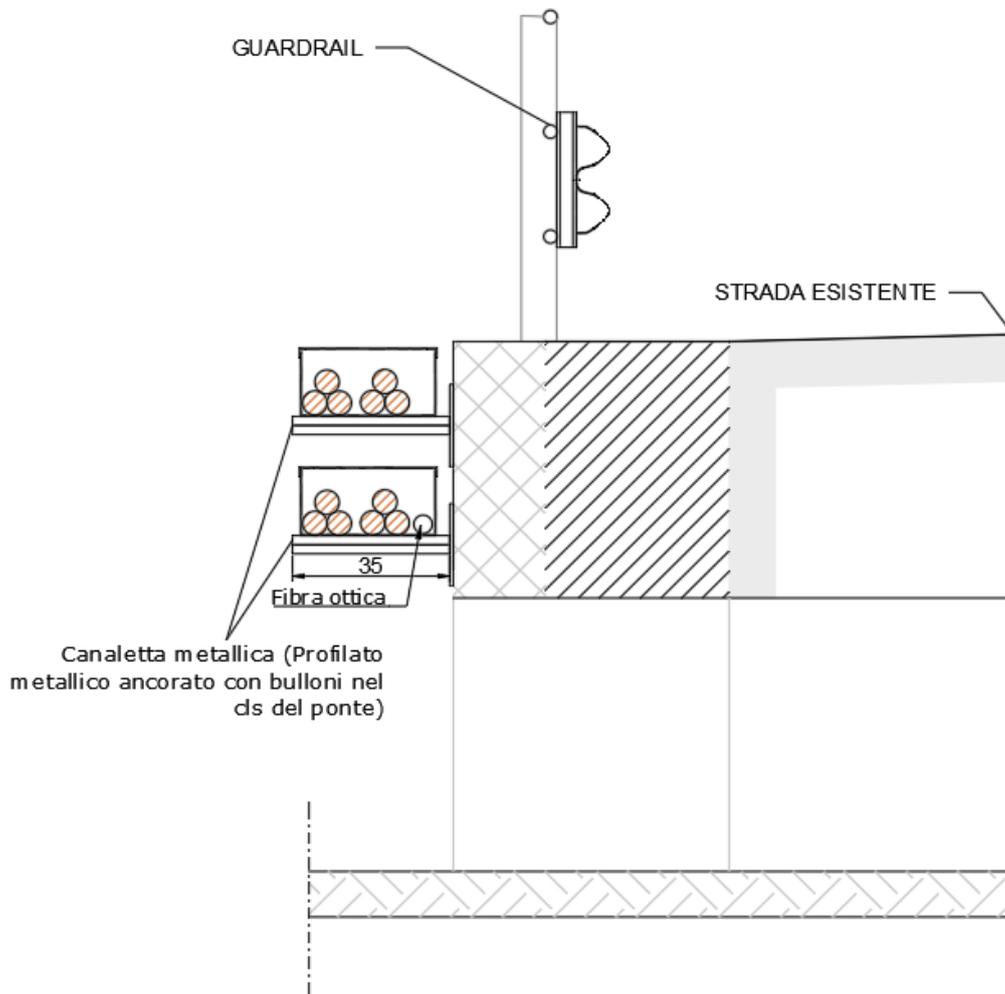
Sezione Cavidotto MT, posa in canaletta in fiancheggiamento al ponte.
